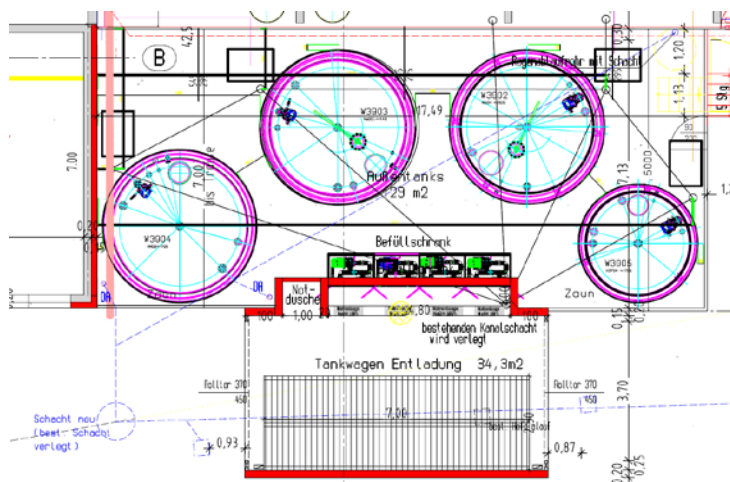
Grundriss der aufgestellten Lagertanks
